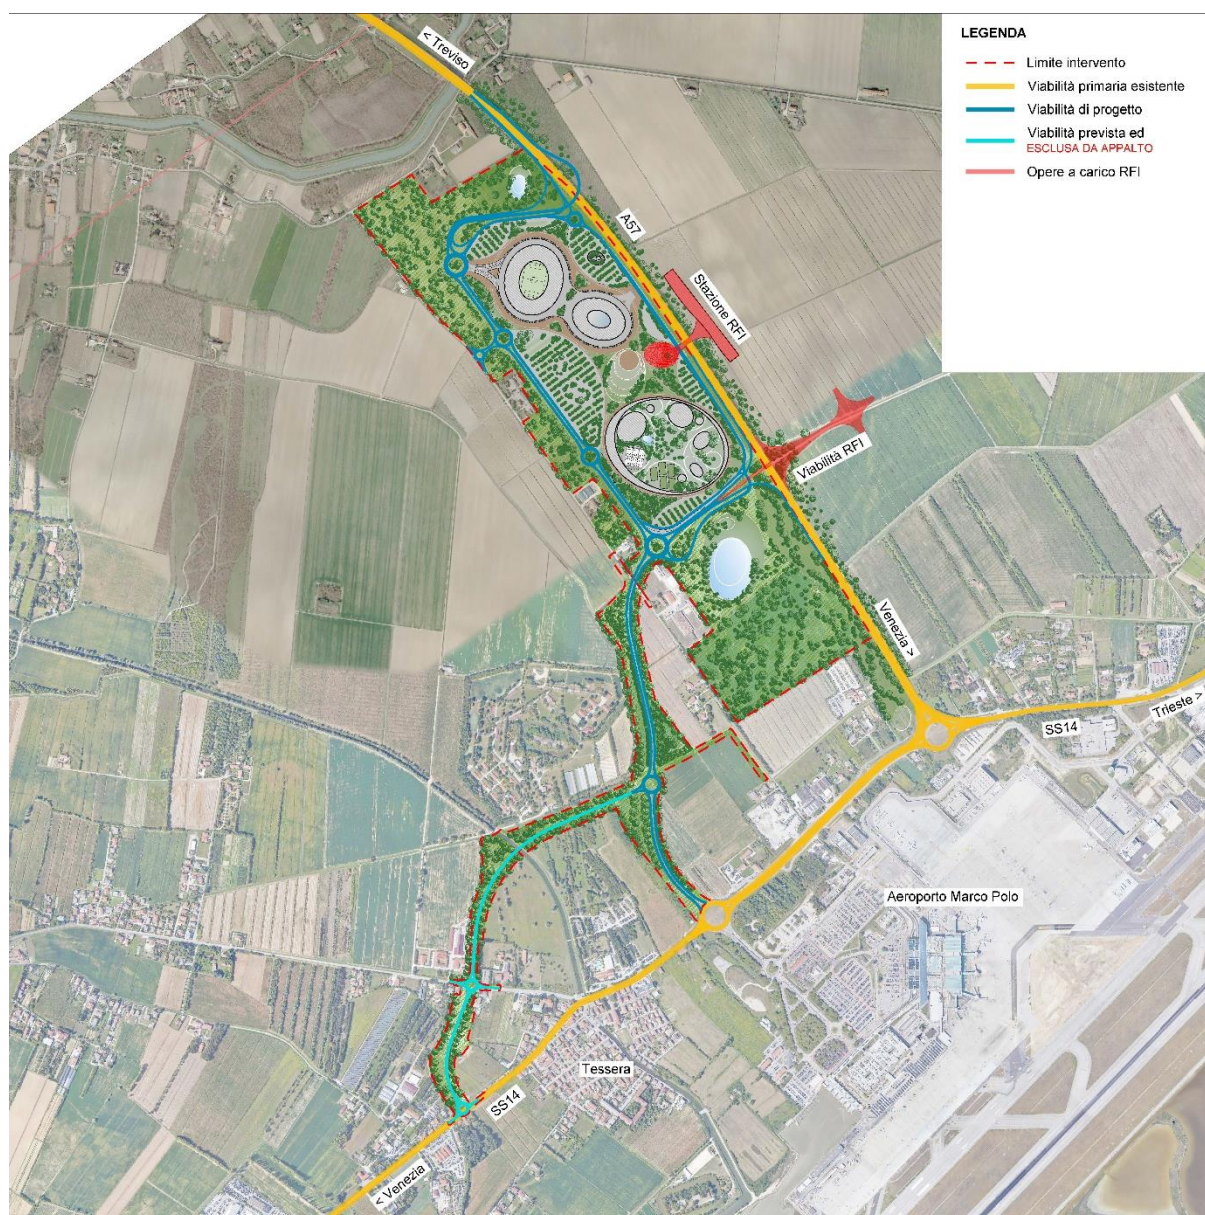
VIABILITA' ESISTENTE E DI PROGETTO PREVISTA
